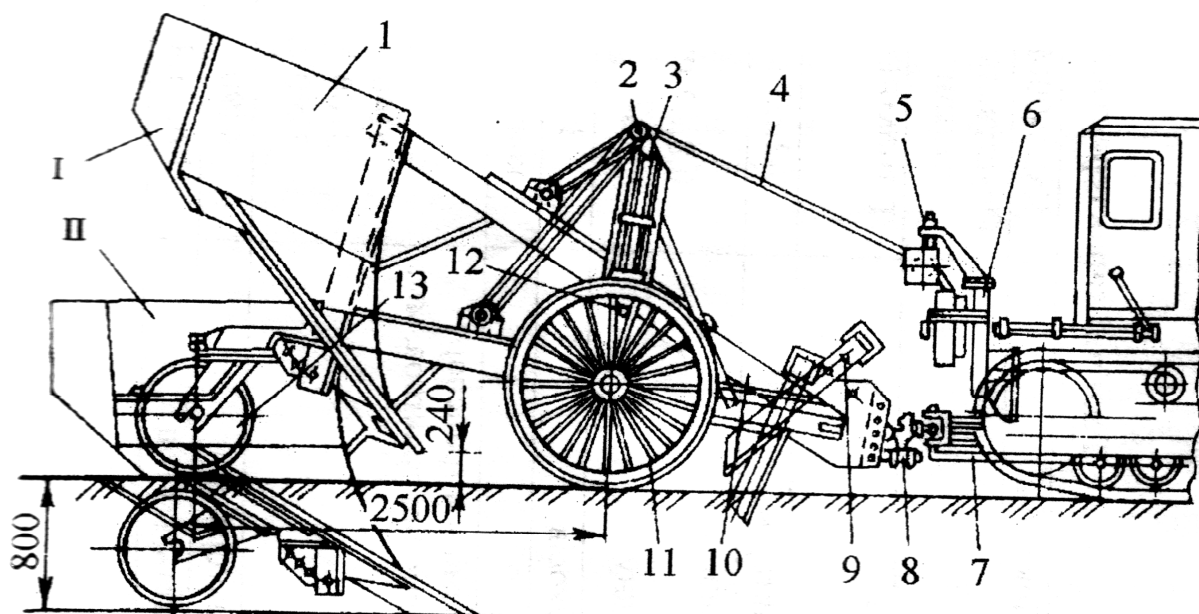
Каналокопач КМ-1400М: 1 – плужний робочий орган; 2 – блок поліспасти; 3 – ходова рама; 4 – канат виглиблення; 5 – флюгерна колонка; 6 – лебідка; 7 – тяговий канат; 8
